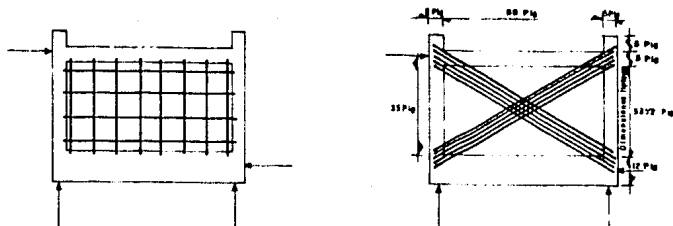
Muros de cortante de concreto reforzado sujetos a cargas monótonas laterales.
